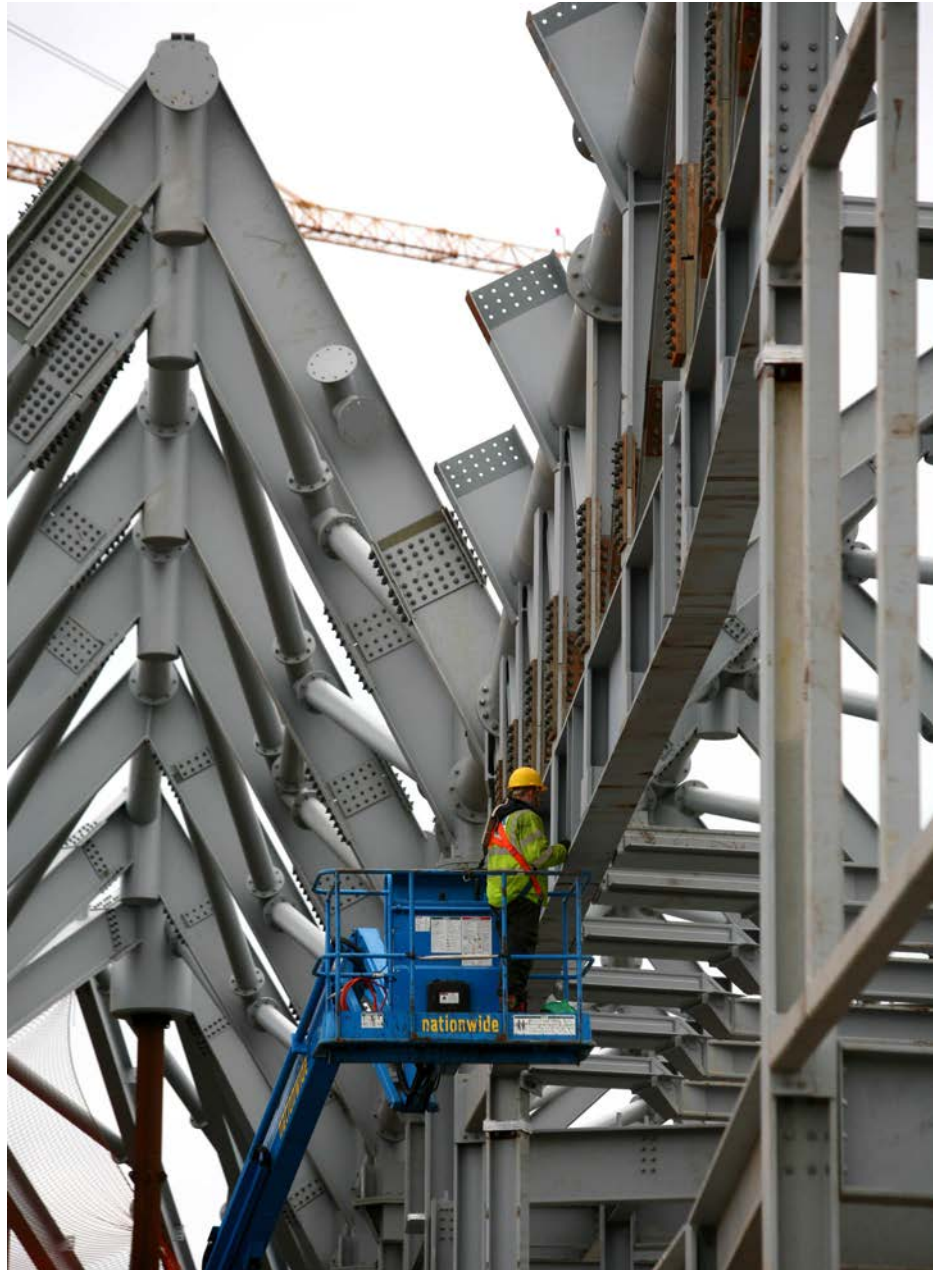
Nave de una sola planta con celosía en el exterior.
